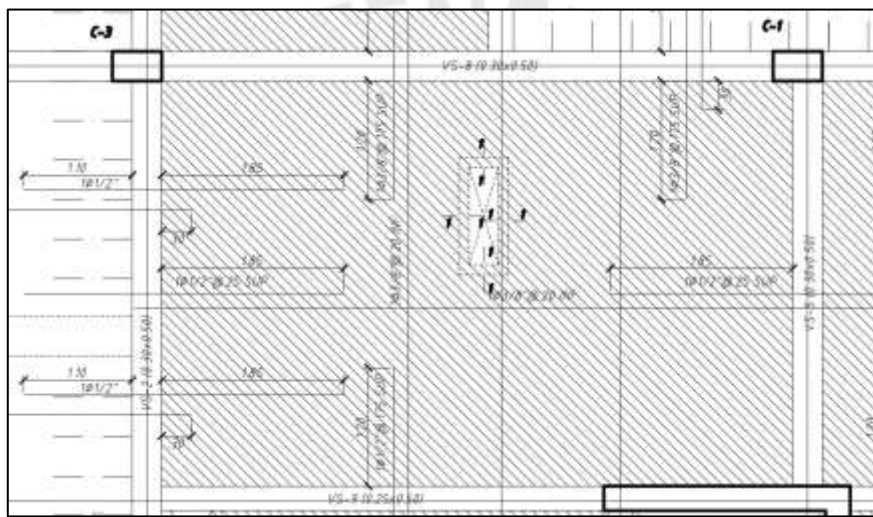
Disposición de acero de refuerzo en la losa maciza 1
